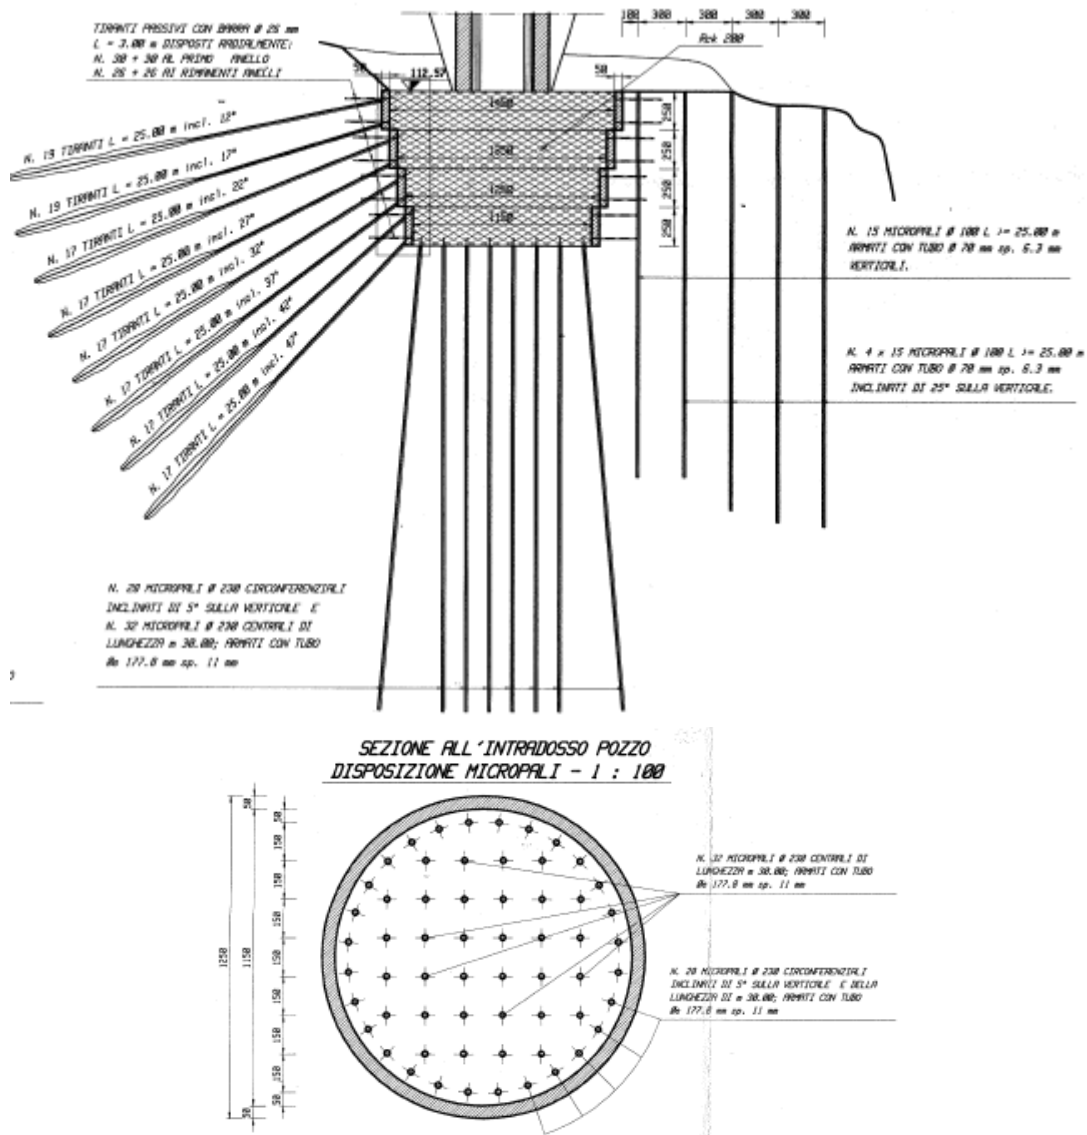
Pianta e sezione pozzi fondazione pile P2, P3
